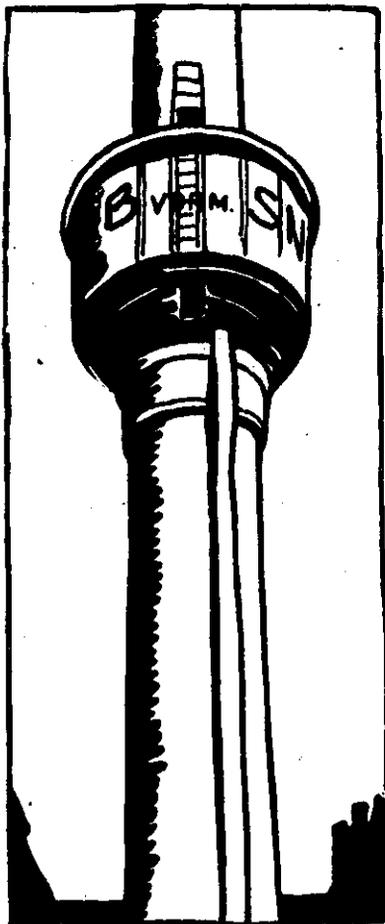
Железо-бетонная водонапорная башня в Секевгейме в Германии.
